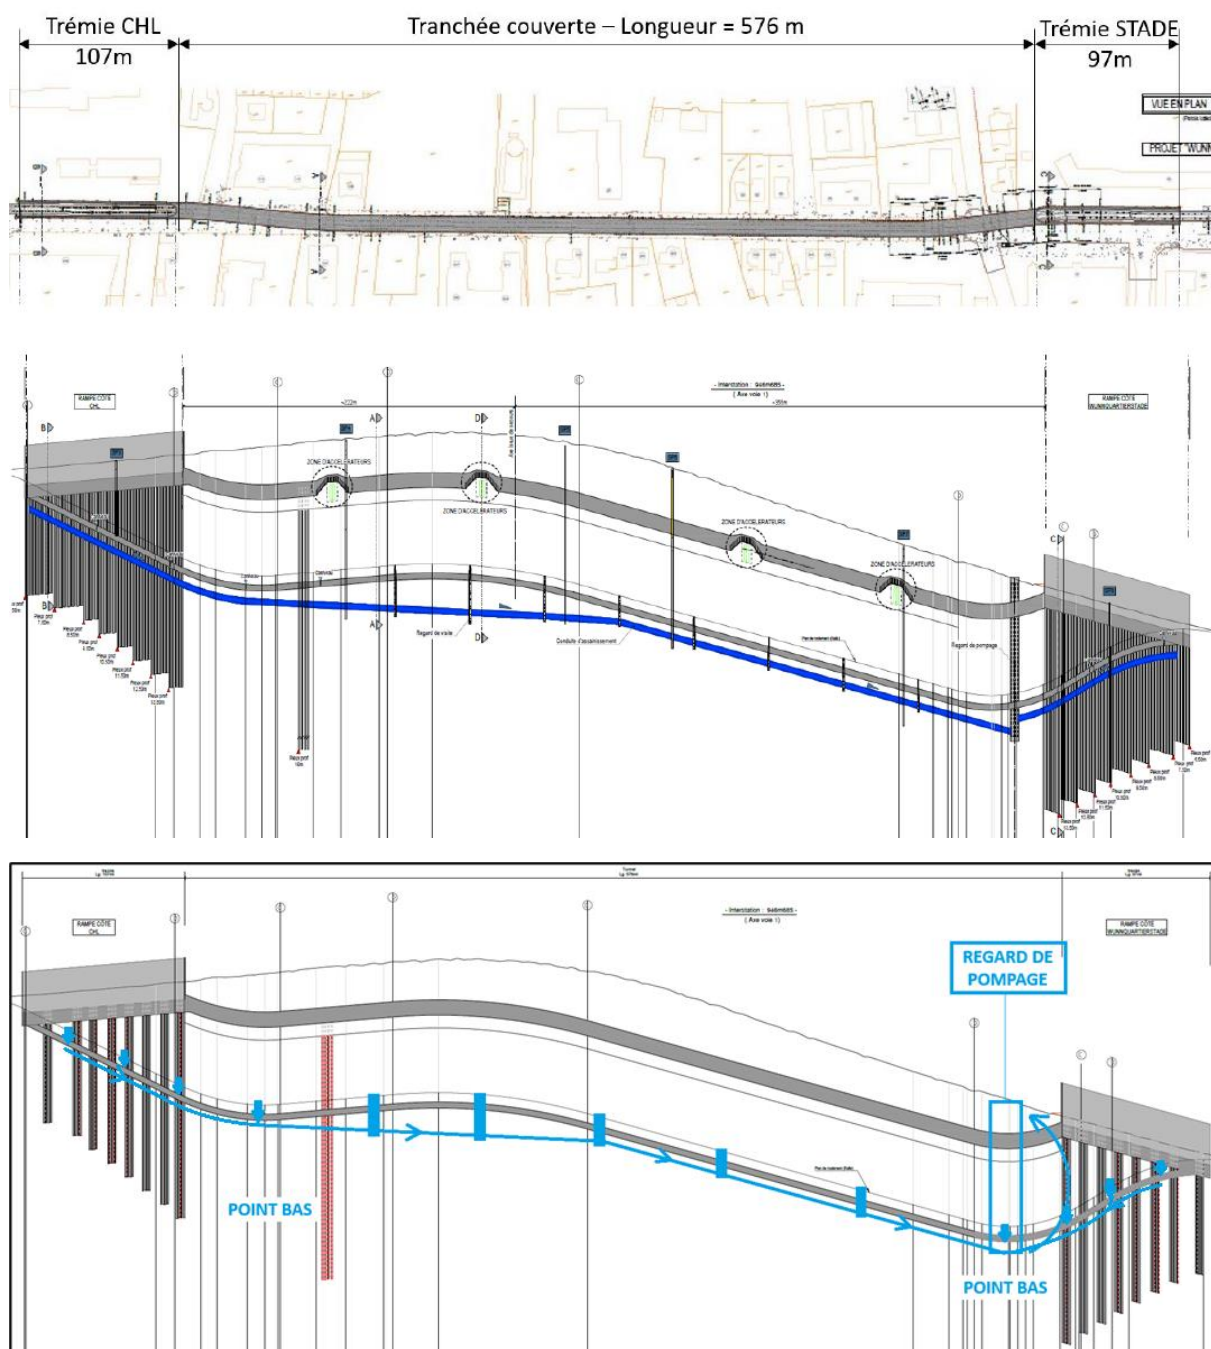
Coupe longitudinale avec concept de drainage du tunnel couvert de la route d'Arlon. Source : APS Volume D2024
